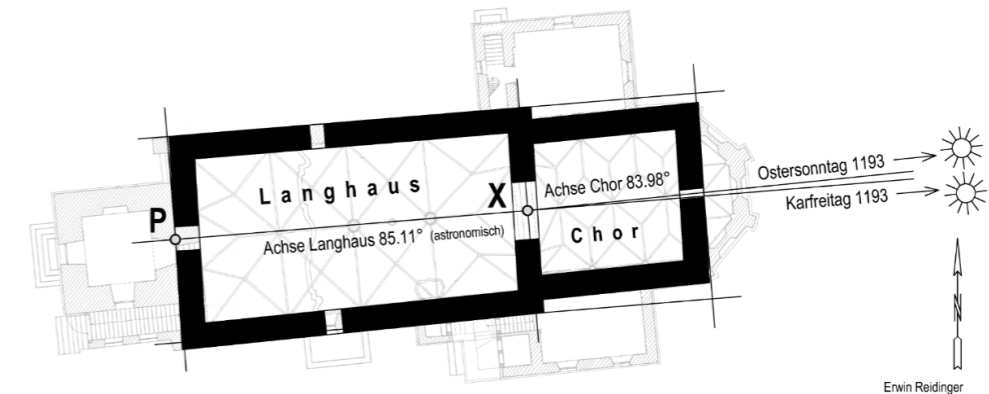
Stadtpfarrkirche Friedberg, Grundriss mit Orientierungstagen 1193 (Karfreitag und Ostersonntag)
